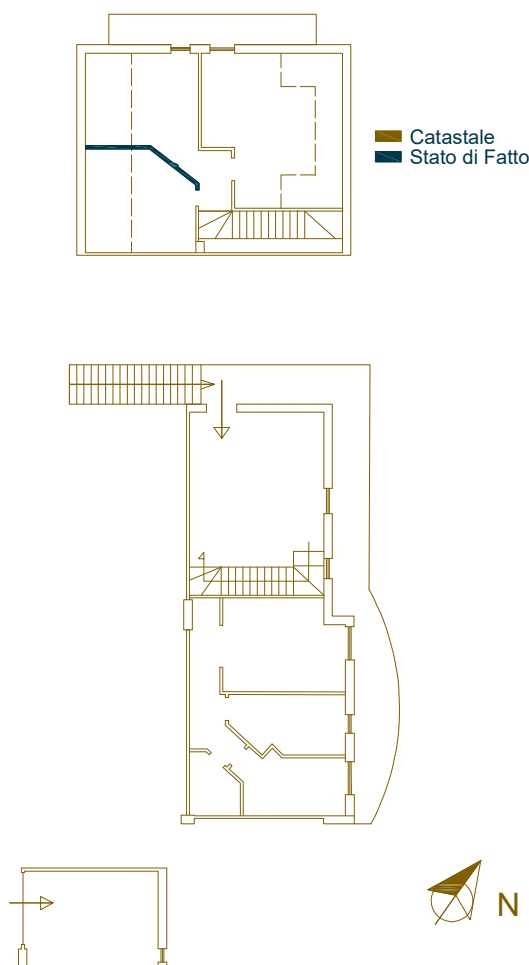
Planimetria di confronto tra il Catastale depositato e la planimetria dello stato di fatto.
